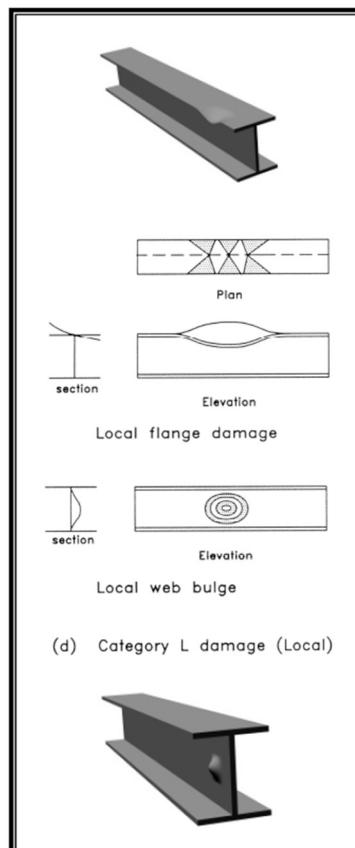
Elementos estruturais sujeitos a deformações localizadas (FHWA, 2008)
